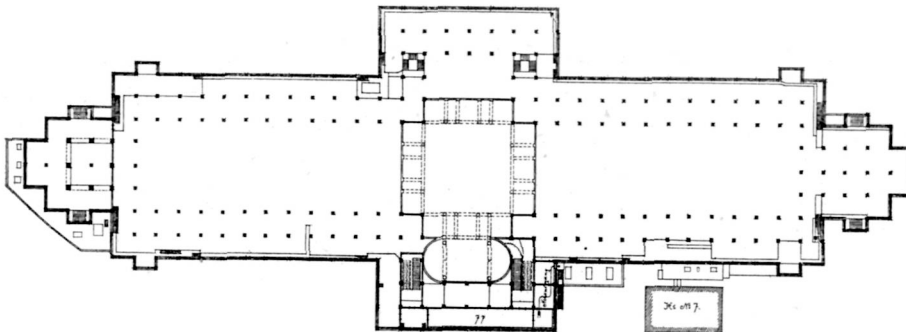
Glaspalast zu München. Obergeschoß-Grundriß
